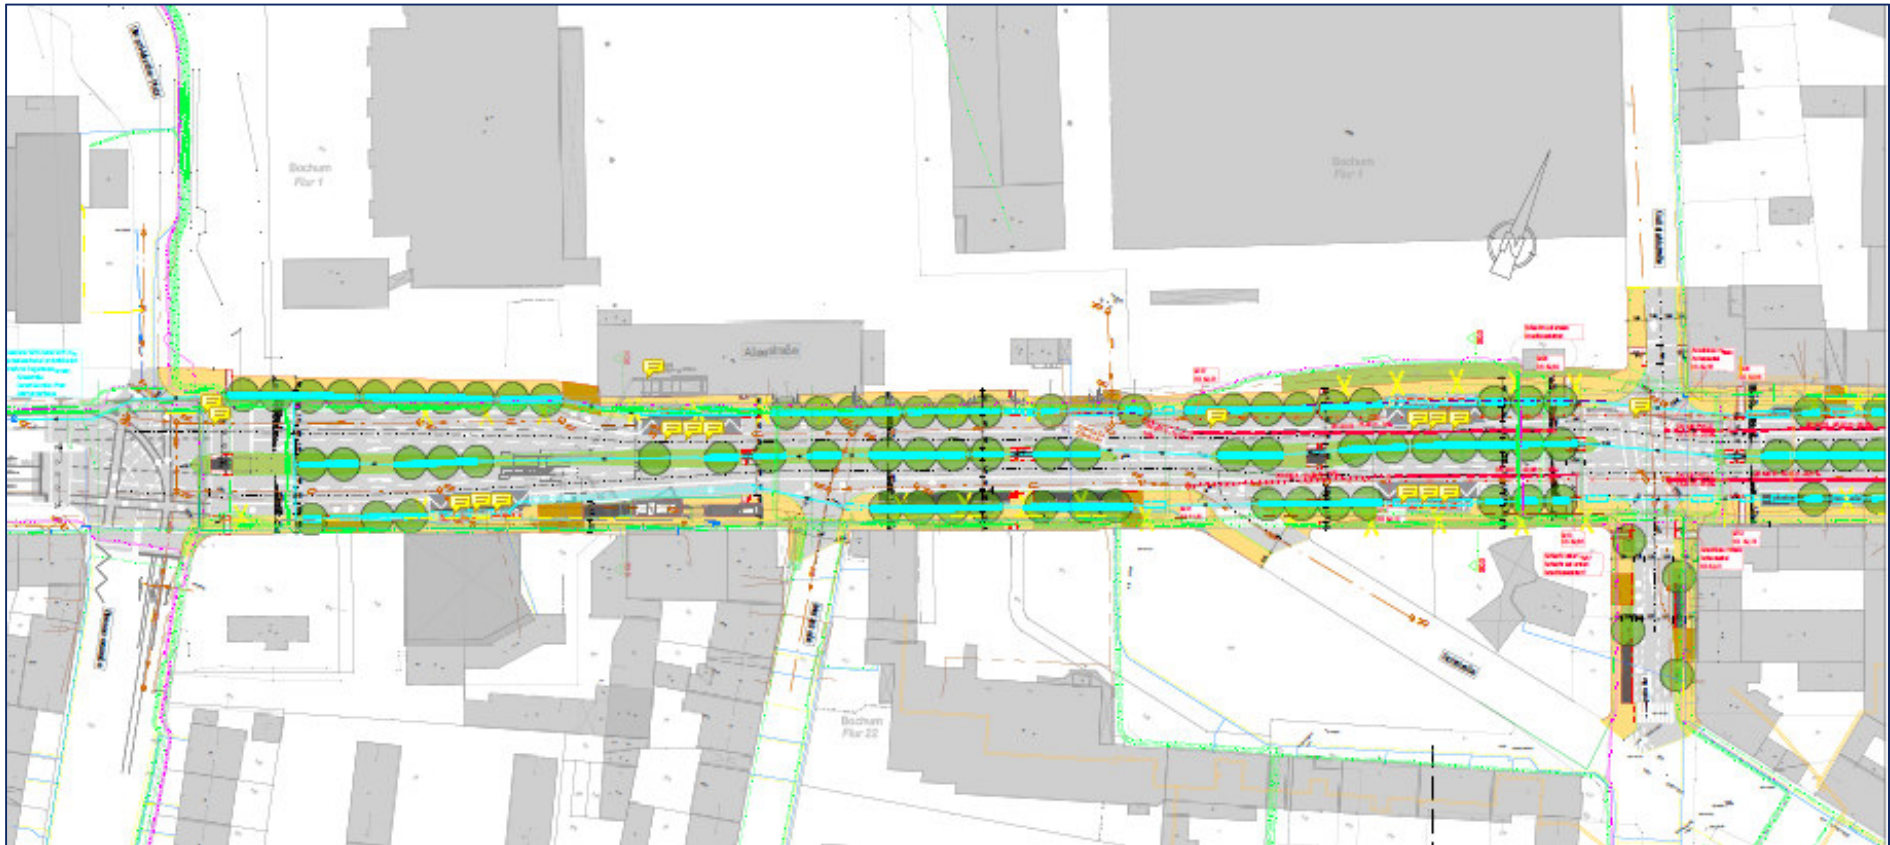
Lageplanausschnitt Alleestraße ©:Stadt Bochum, Fischer Teamplan
